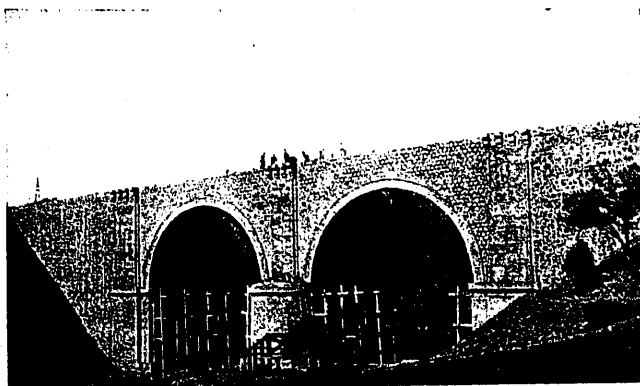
ª El nuevo puente casi terminado y prestando servicio
